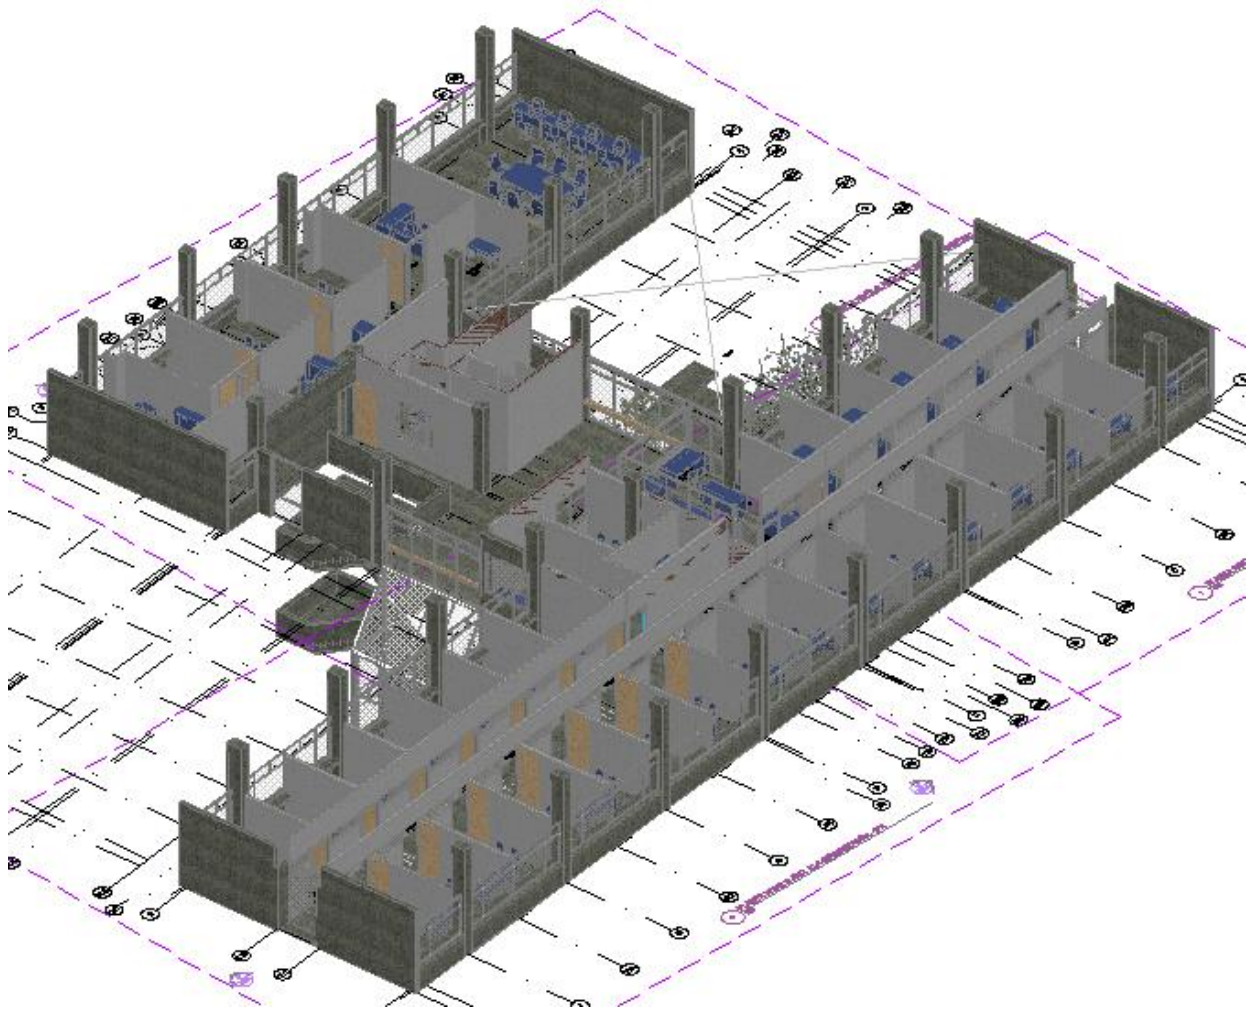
Modelo arquitectónico general del Nivel 2.
